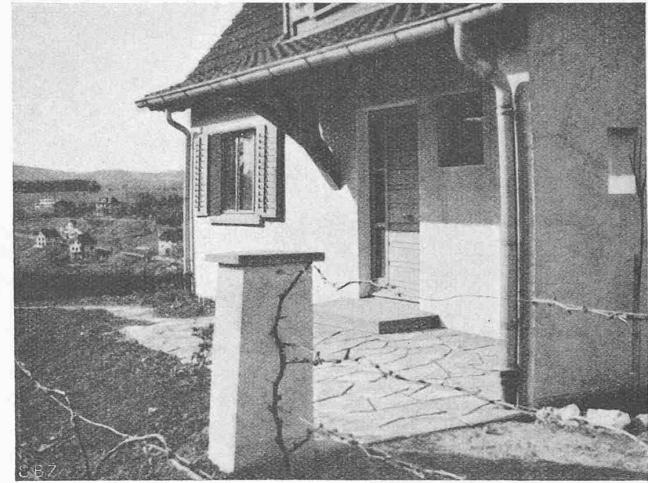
Südwestfront mit gedecktem Sitzplatz vor dem Hauseingang
